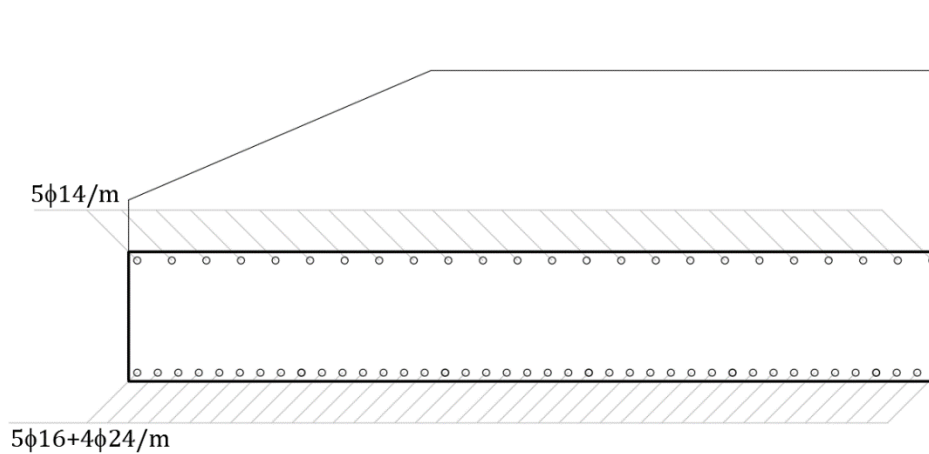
Dettaglio plinto cavalcavia 312 - Sezione longitudinale
